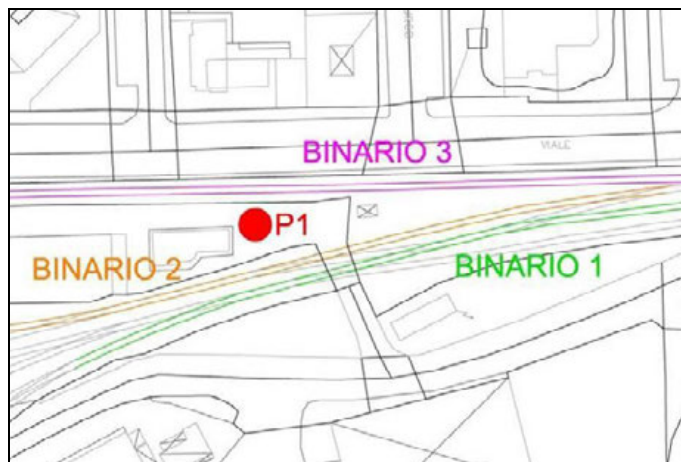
Localizzazione planimetrica della postazione di misura ferroviaria
